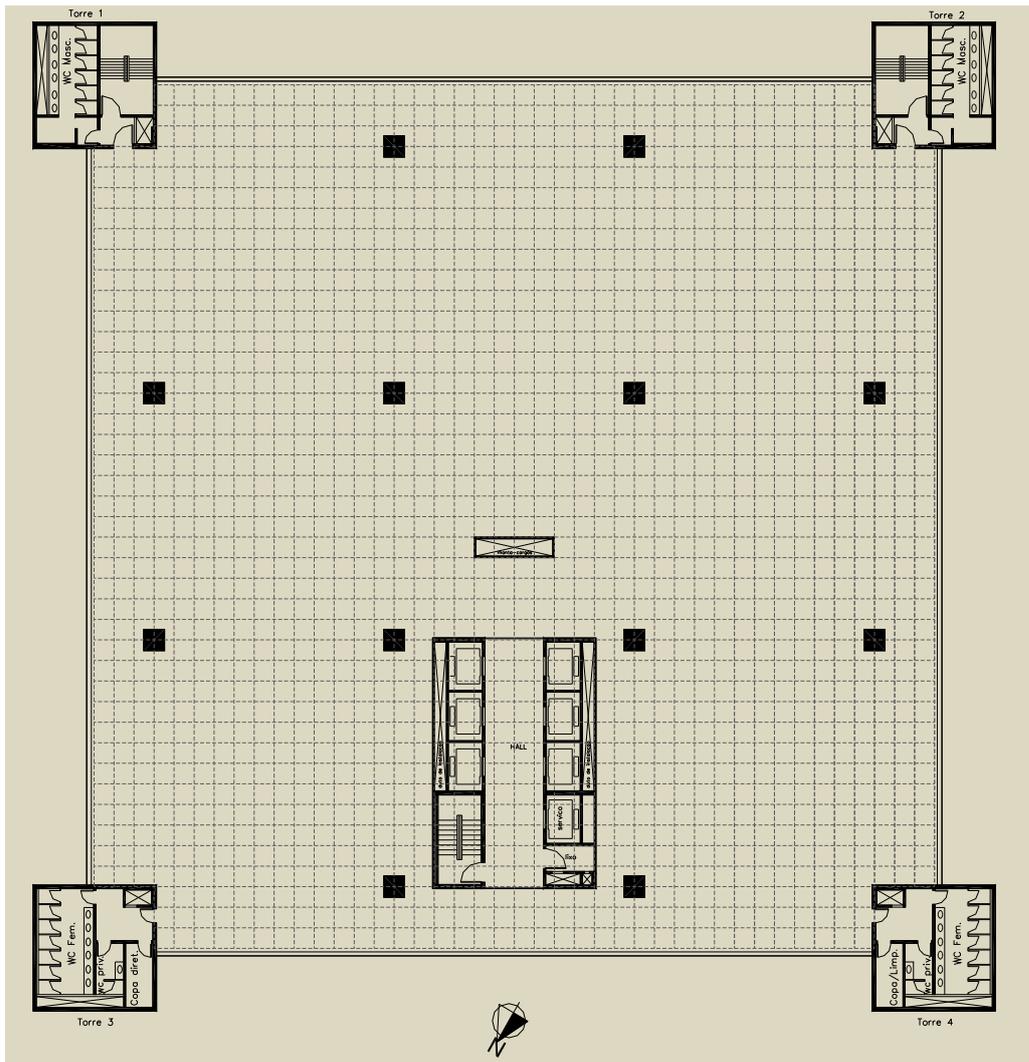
Planta do pavimento tipo com malha de forro na modulação 1.25 x 1.25 m.
